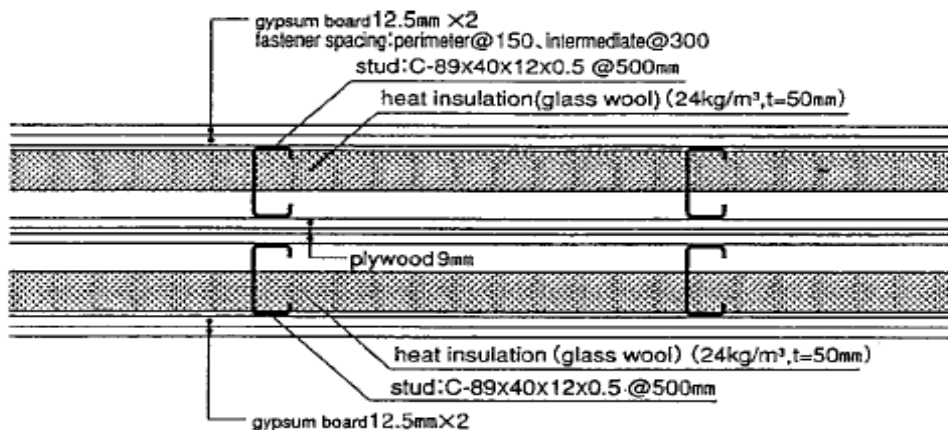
Ejemplo de perfiles y dimensiones utilizados en el ensayo de un muro doble.
